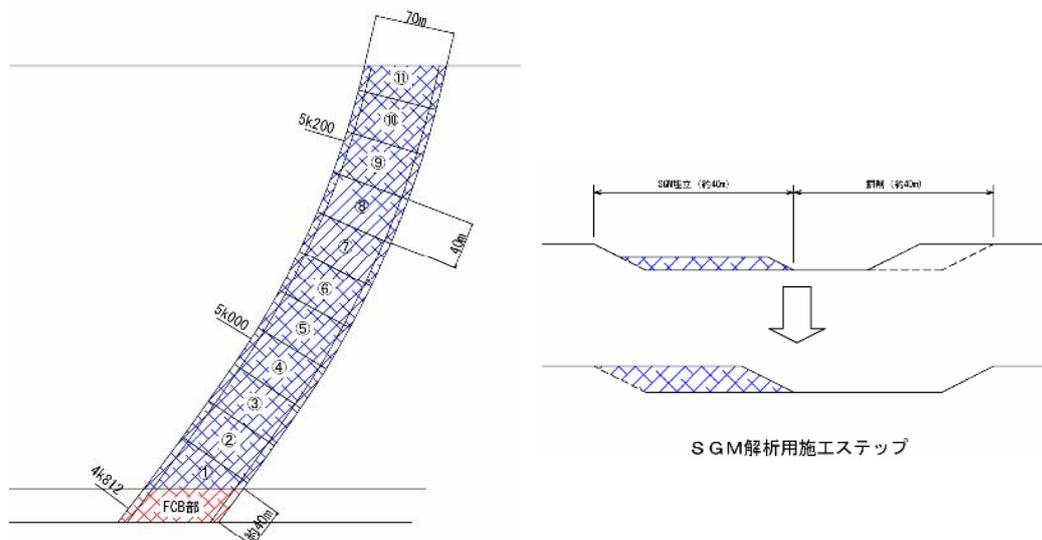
軽量盛土工施工ブロック分割及びSGM解析用施工ステップ図
